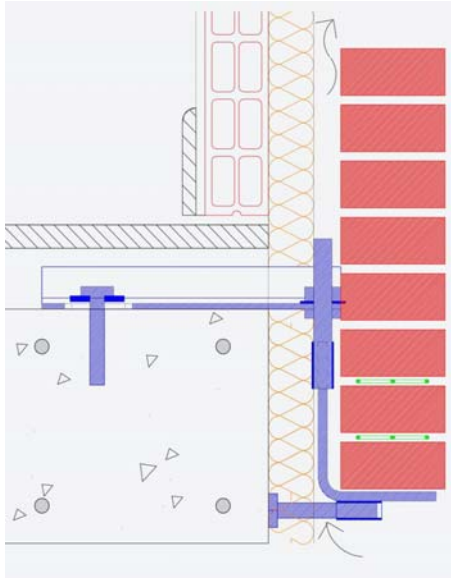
Sección en la vertical del Apoyo Pi (Halfen-AllWall) anclado al forjado, que muestra las dos armaduras de tendel Murfor del tirante, y la capacidad de aislamiento y ventilación de la cámara continua, y capacidad de regulación del Apoyo Pi.
